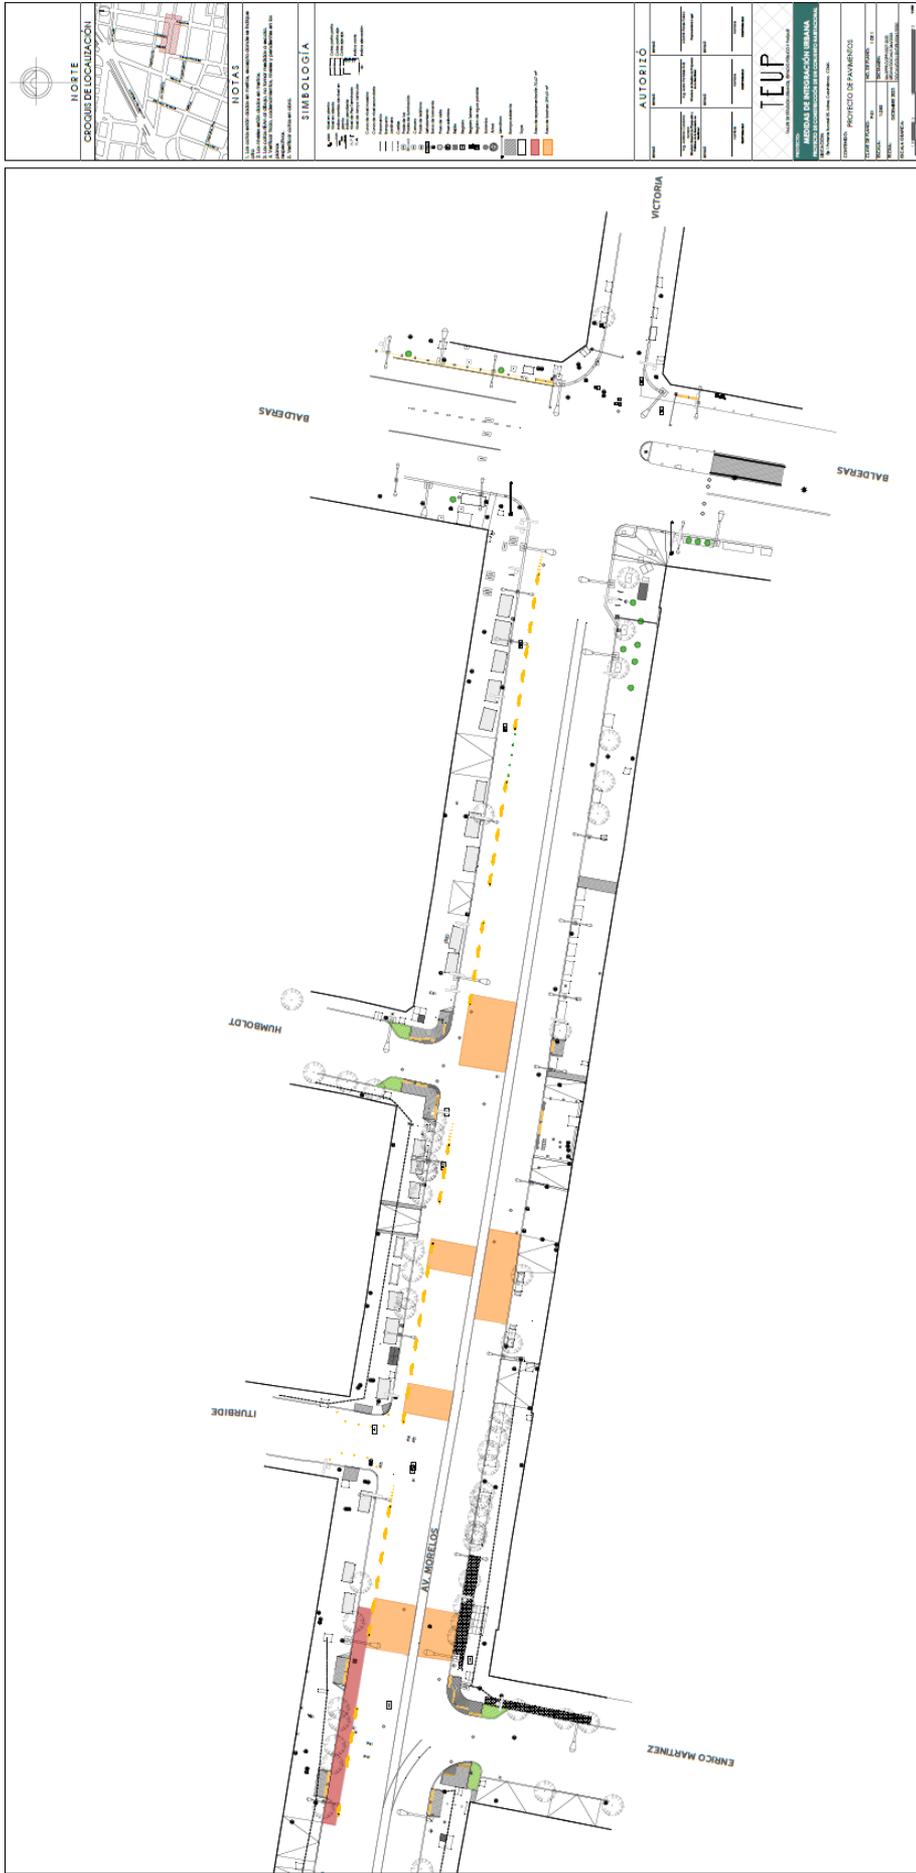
Proyecto de pavimentos, propuesta final. Fuente TEUP
